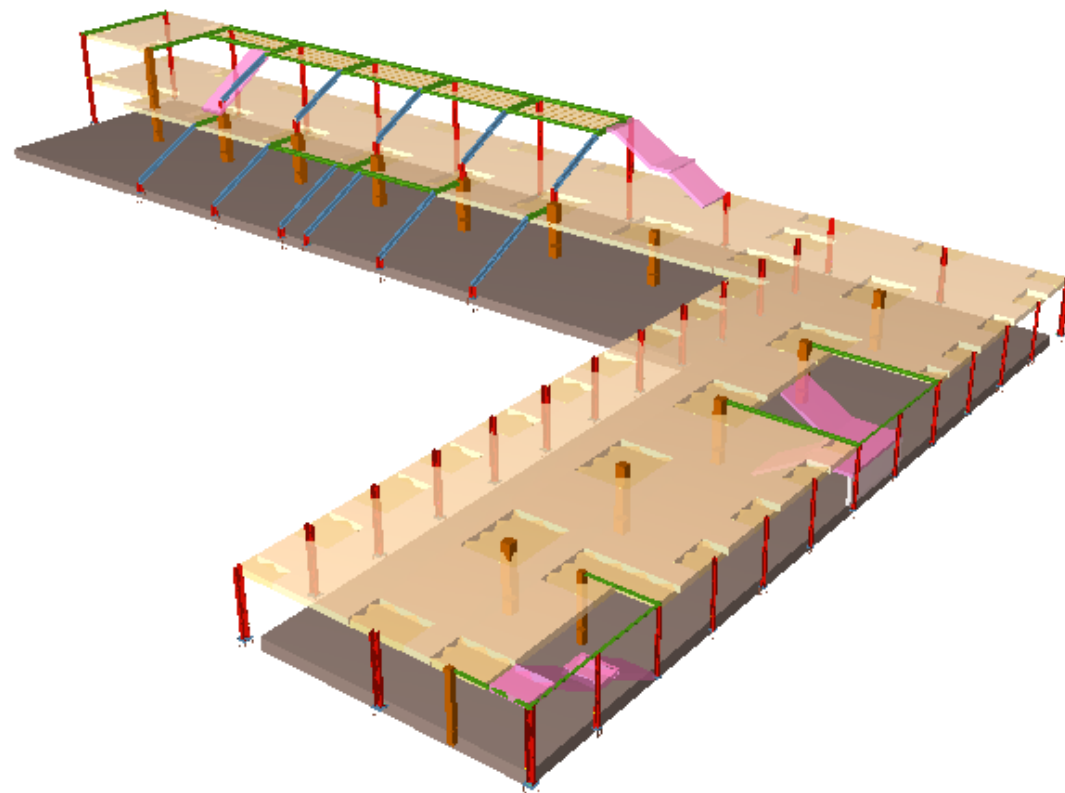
Pórtico tipo de la estructura auxiliar. Fuente: Propia
